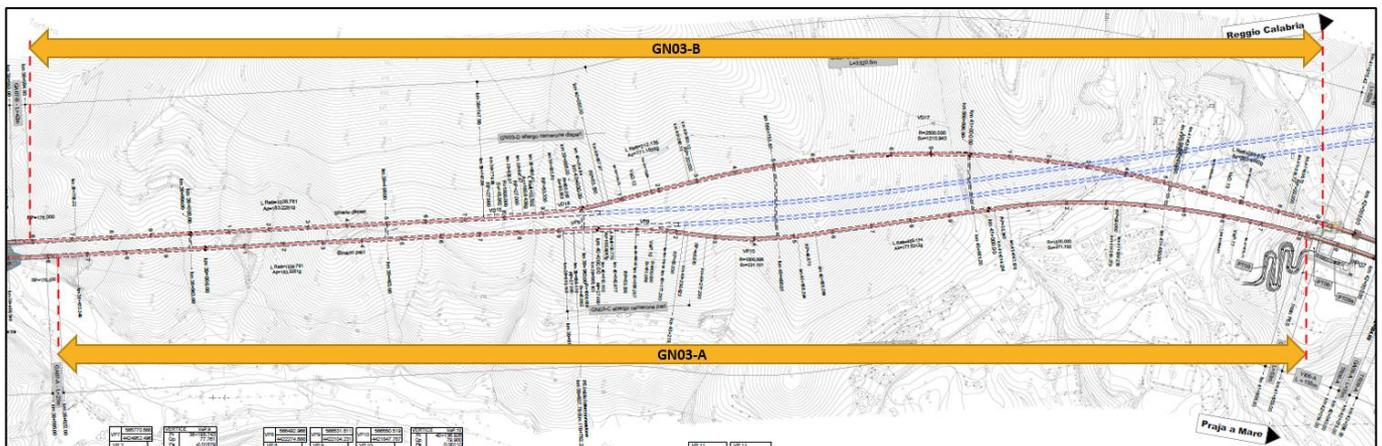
Planimetria di progetto gallerie GN03-A/B da km 38+595 al km 41+859 BP
